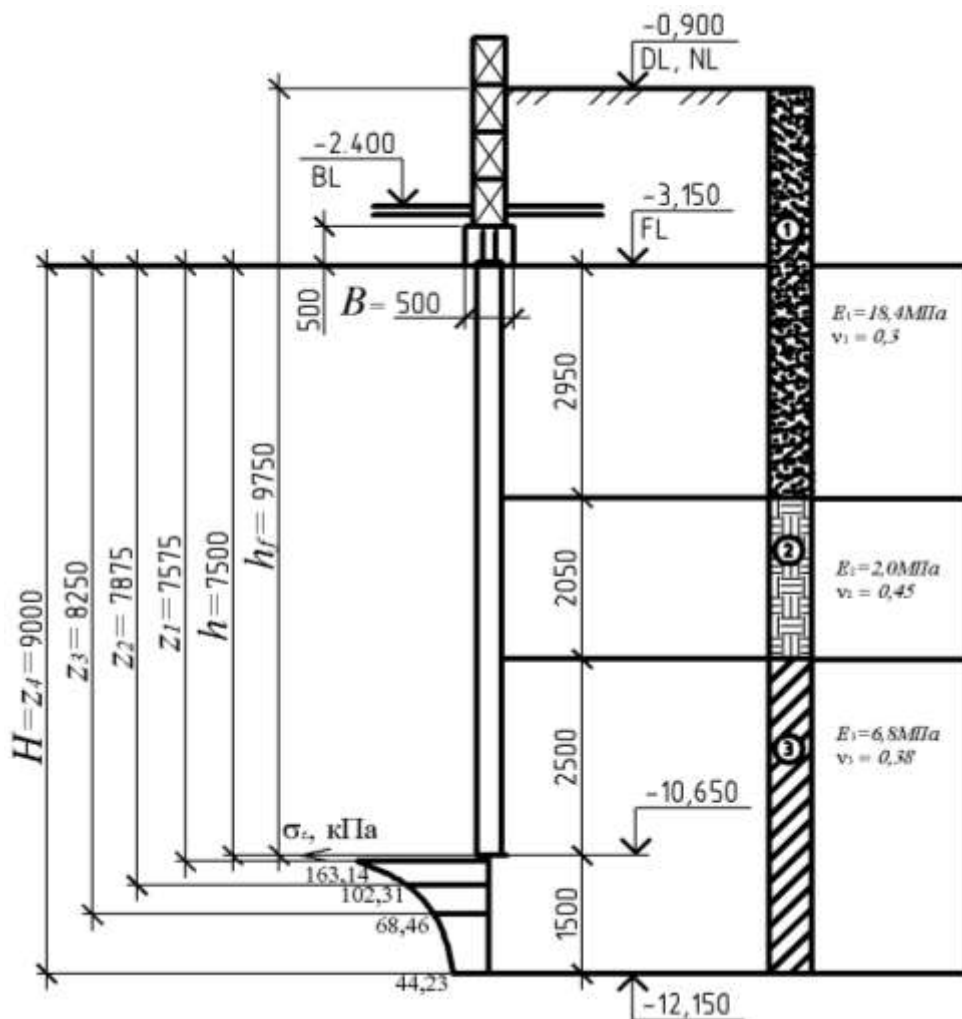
Расчетная схема к примеру 9.2.1.
